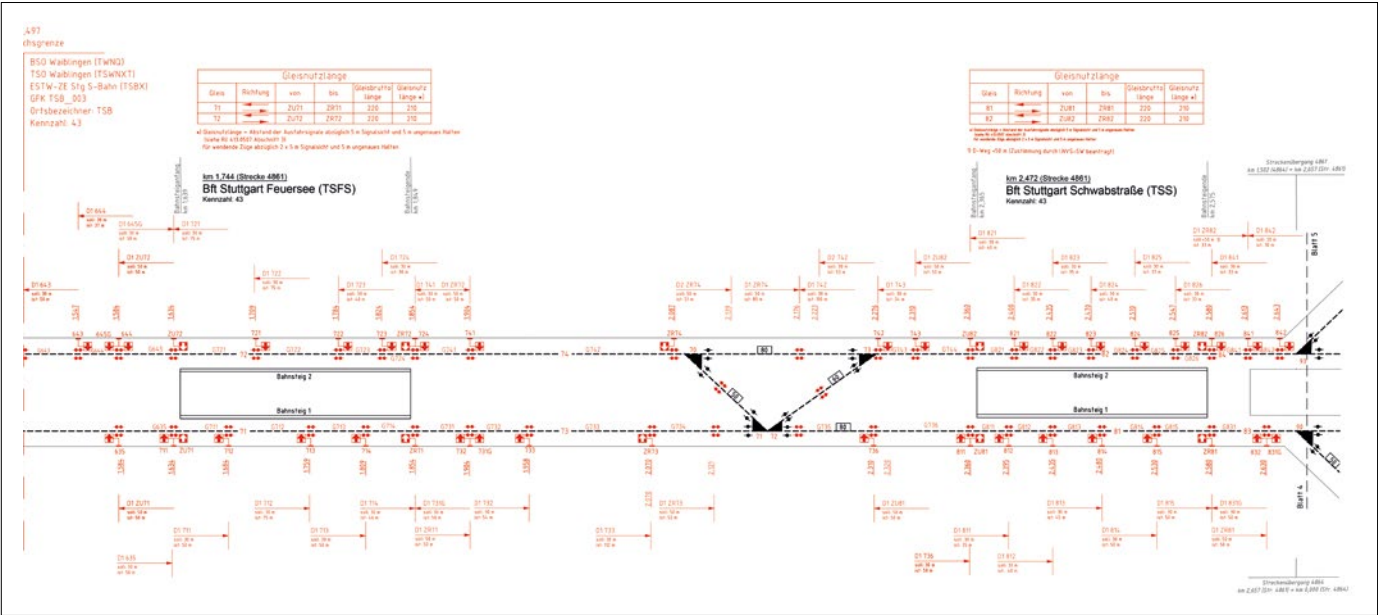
Vereinfachter Auszug aus einem LST-Übersichtsplan der Stammstrecke
